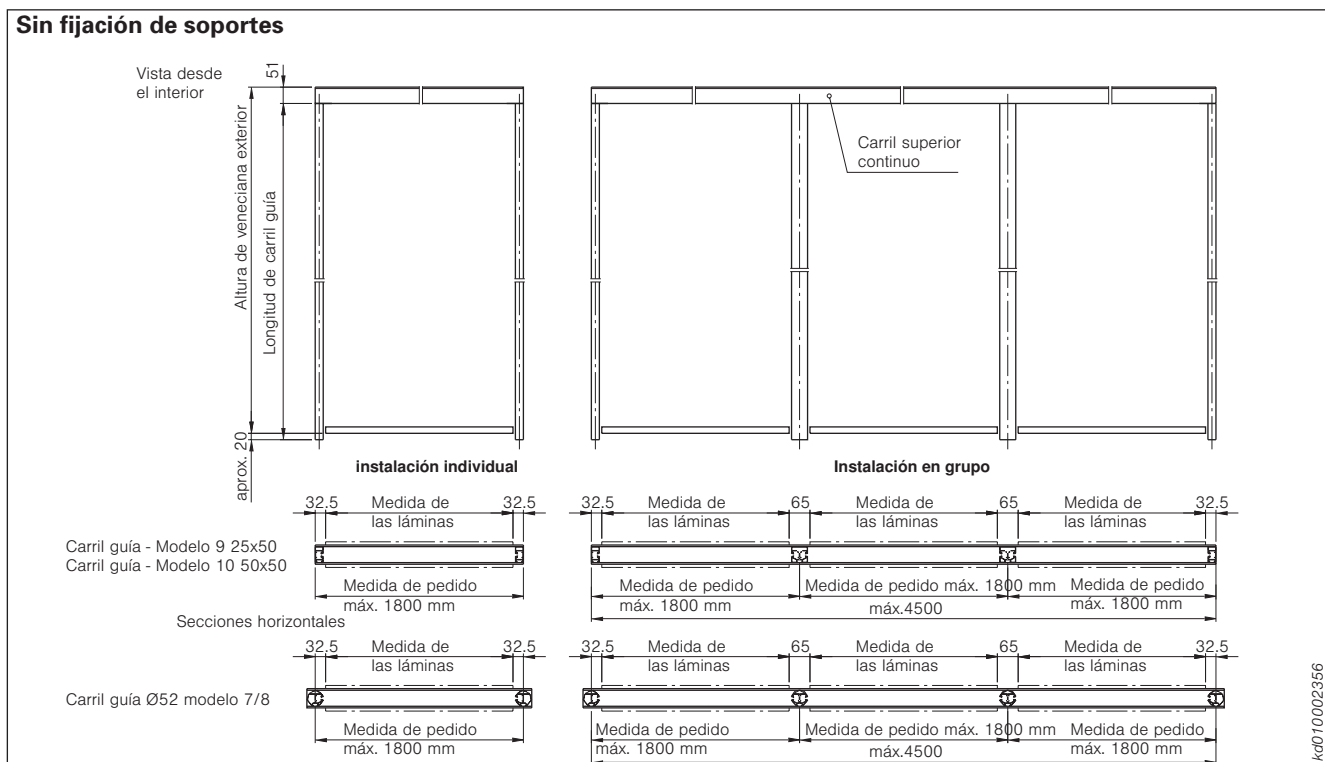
Guía de medidas montaje del carril superior sobre los carriles guía
